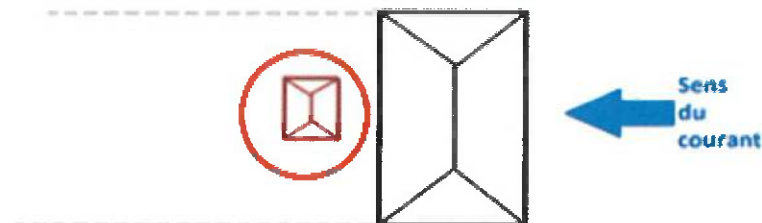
Construction située dans l'ombre hydraulique d'un bâtiment
